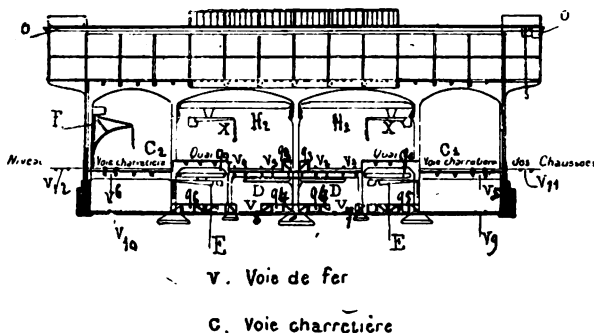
Coupe transversale de la gare de New Bridge street, à Newcastle.
